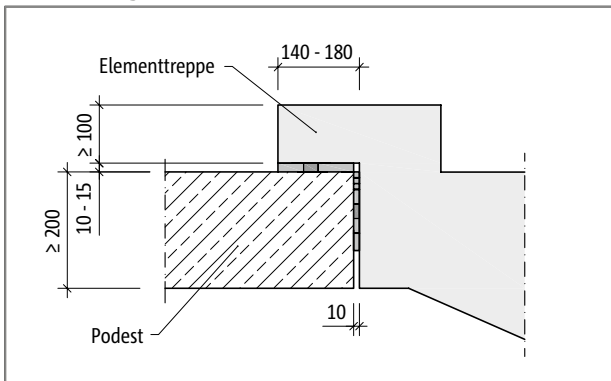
Schöck Tronsole® Typ BL: Ausführungsvariante Auflagerung eines Elementtreppenlaufs am Podestrand
